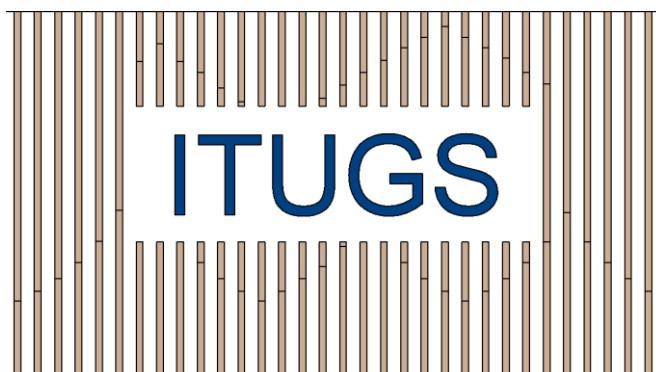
Detalle 1 Muro ingreso . Fuente: Elaboración propia.
